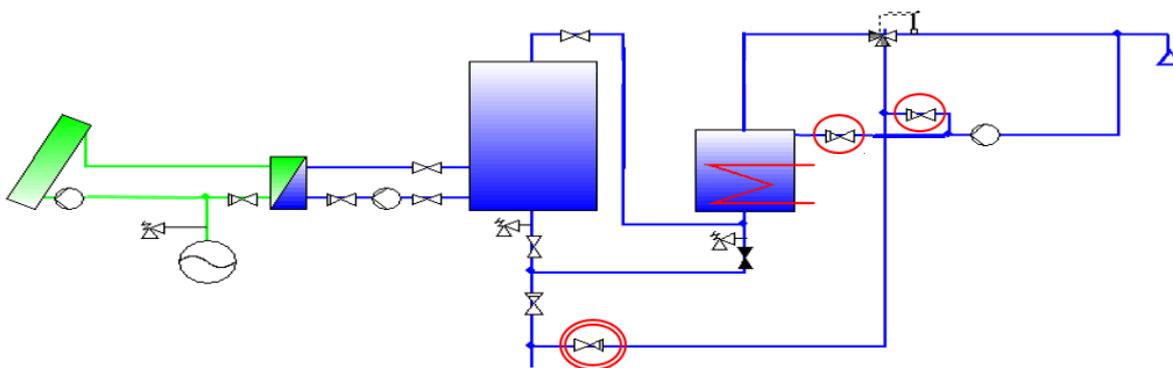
Clapets sur installation avec bouclage et mitigeage
